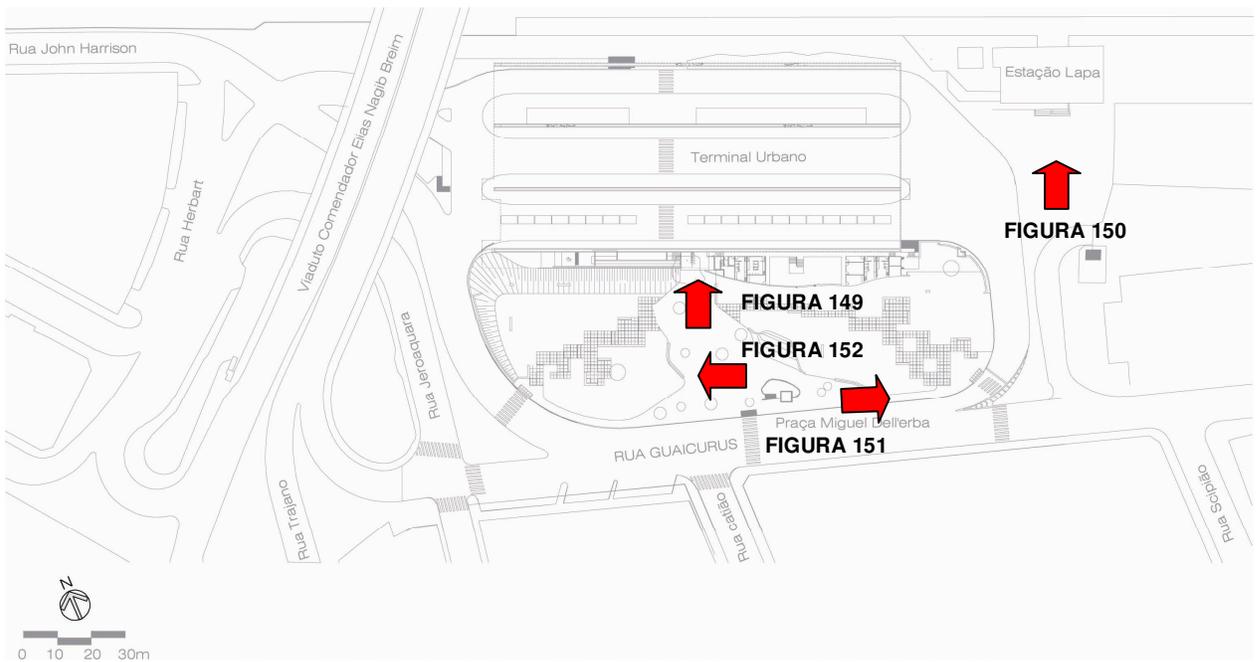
Planta da Praça Miguel Dell' Erba com a indicação das fotos
